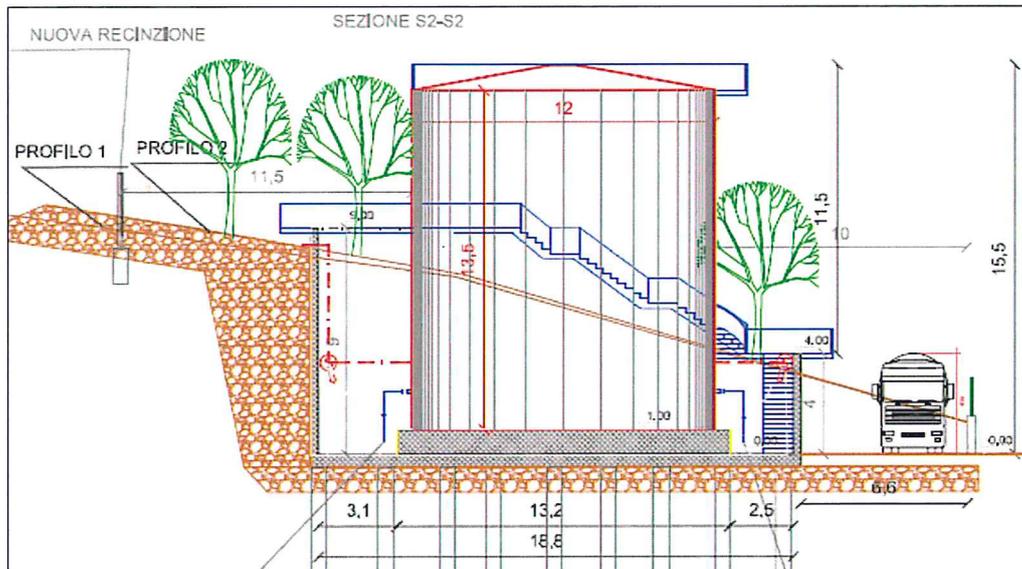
Sezioni di progetto (da Elab. T9 allegato allo SPA)
